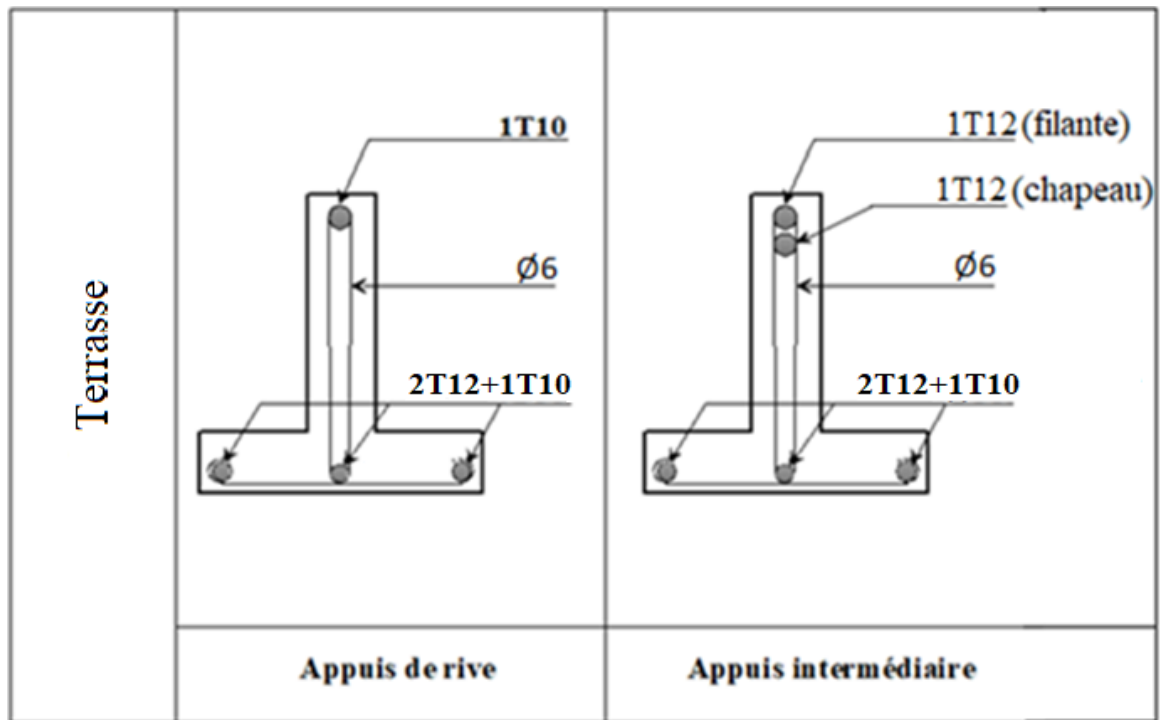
Dessin de ferrailage des poutrelles du plancher terrasse
